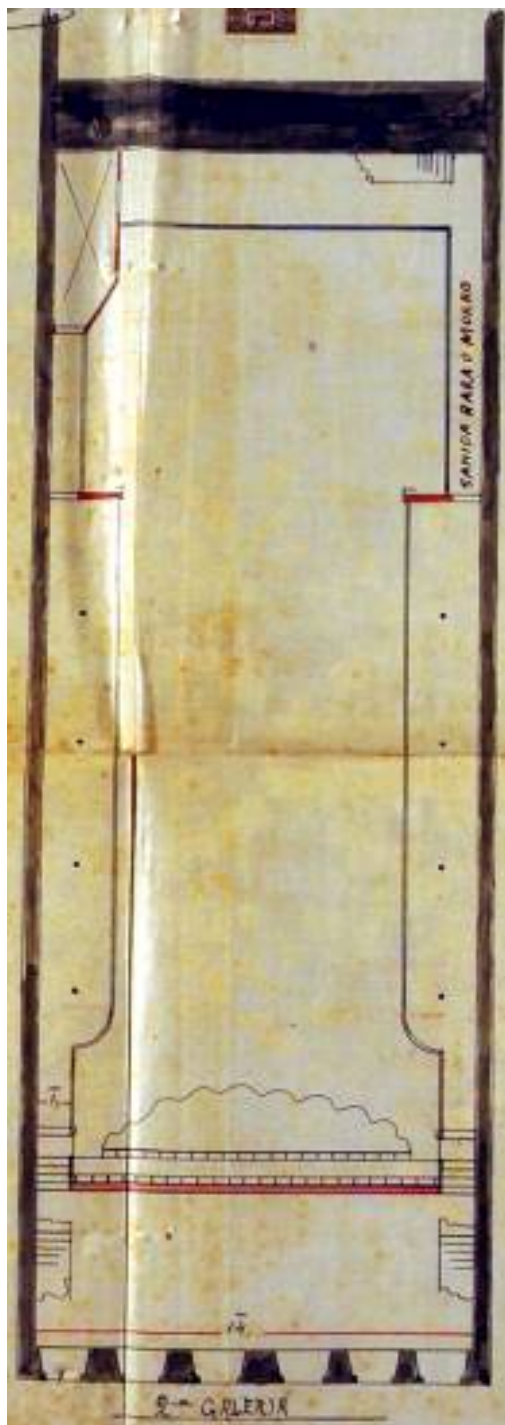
Planta da segunda galeria. Fonte: AGCRJ.
